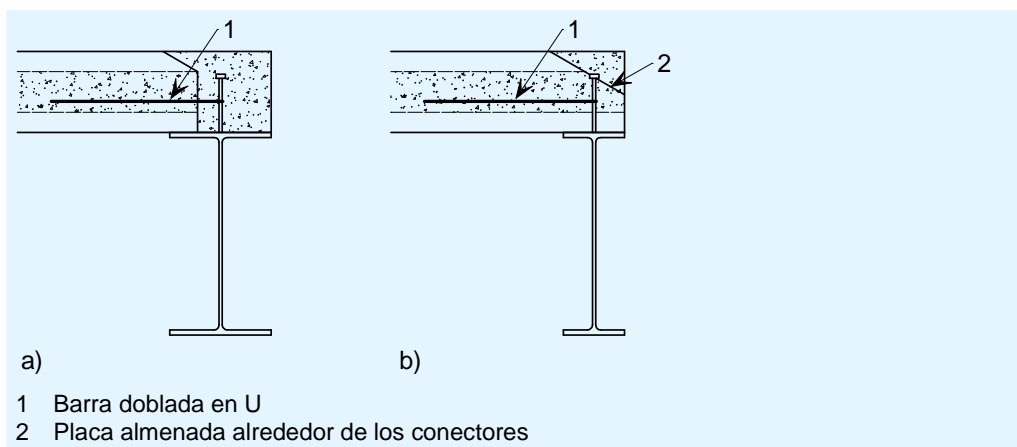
Atado de placas prefabricadas en vigas de borde
